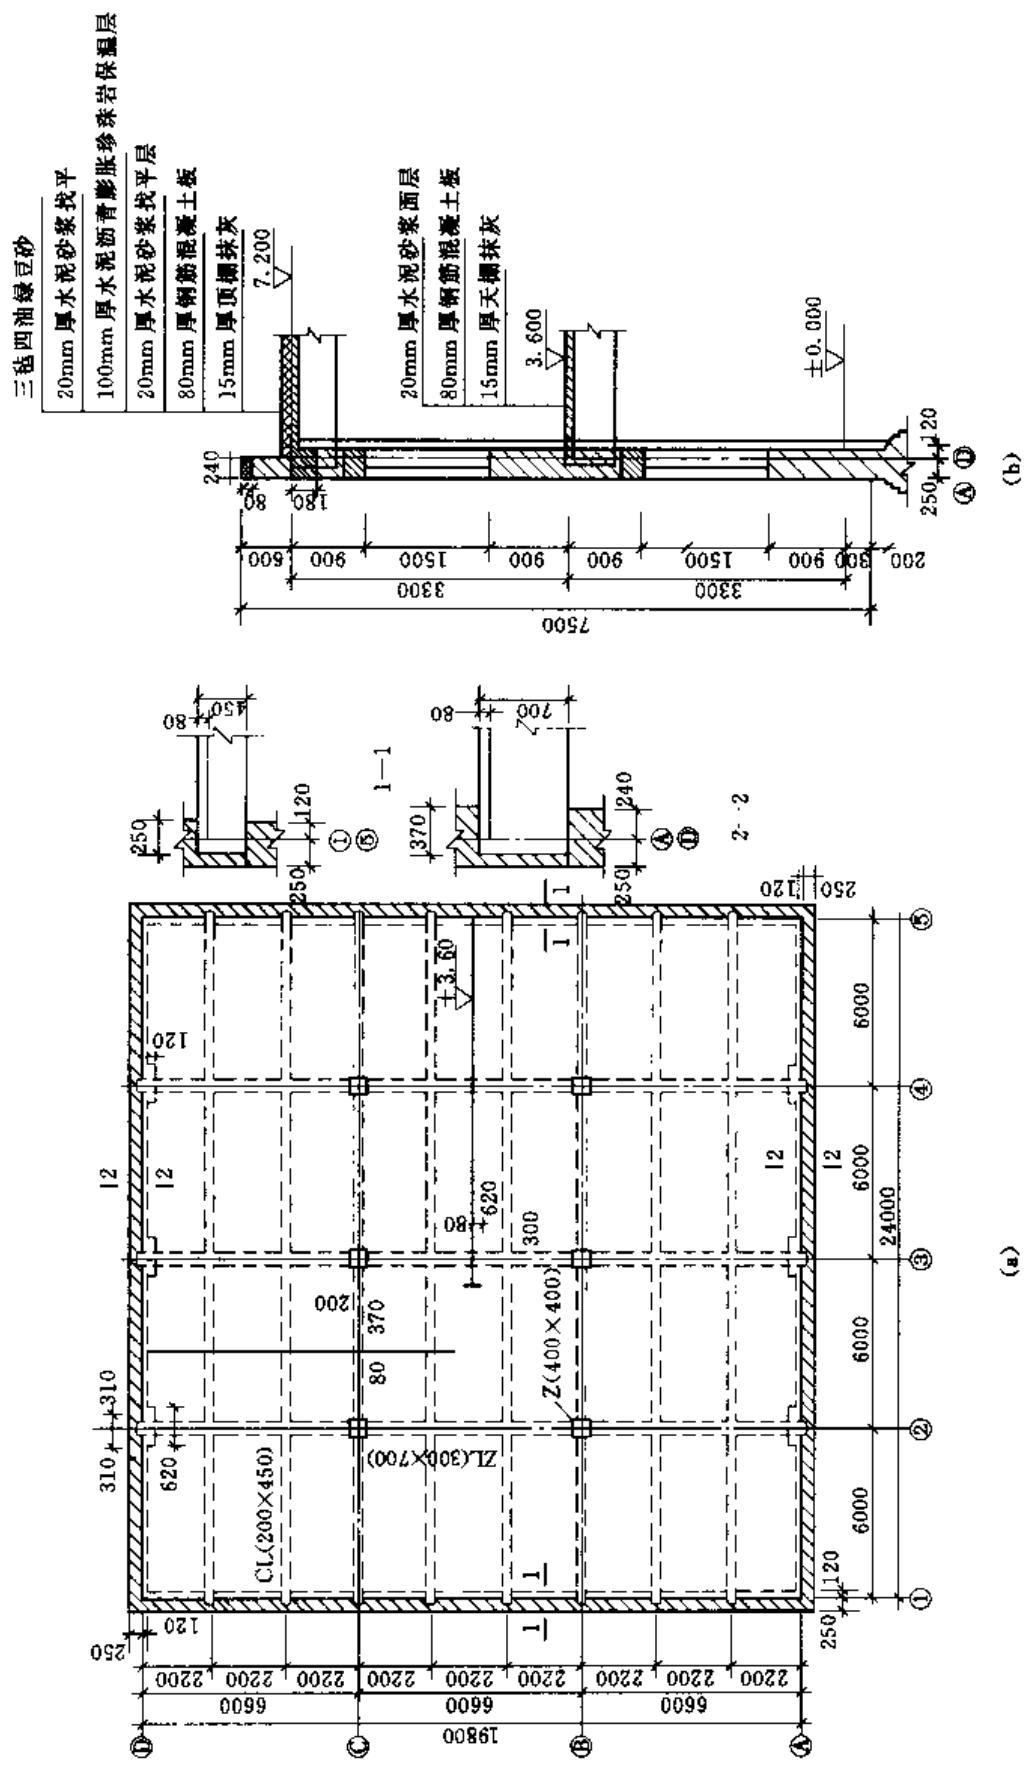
现浇单向板肋梁盖结构平面布置图 (单位: mm)
